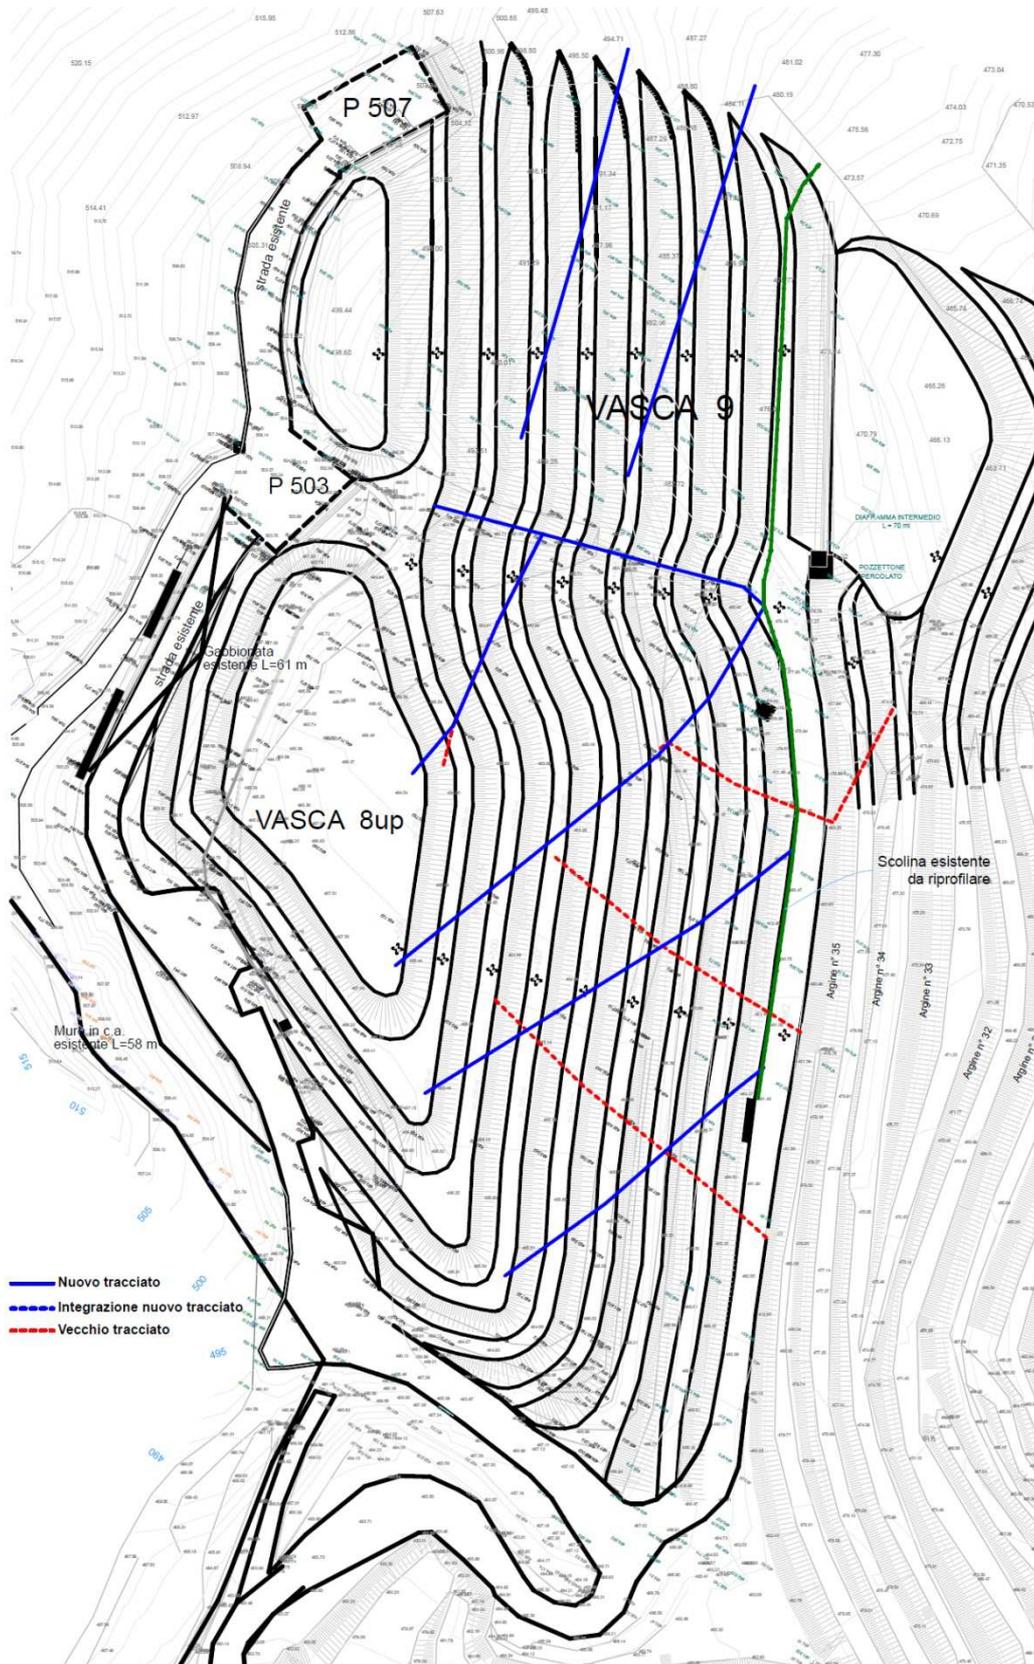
planimetria del reticolo idraulico superficiale come da pendenze naturali
